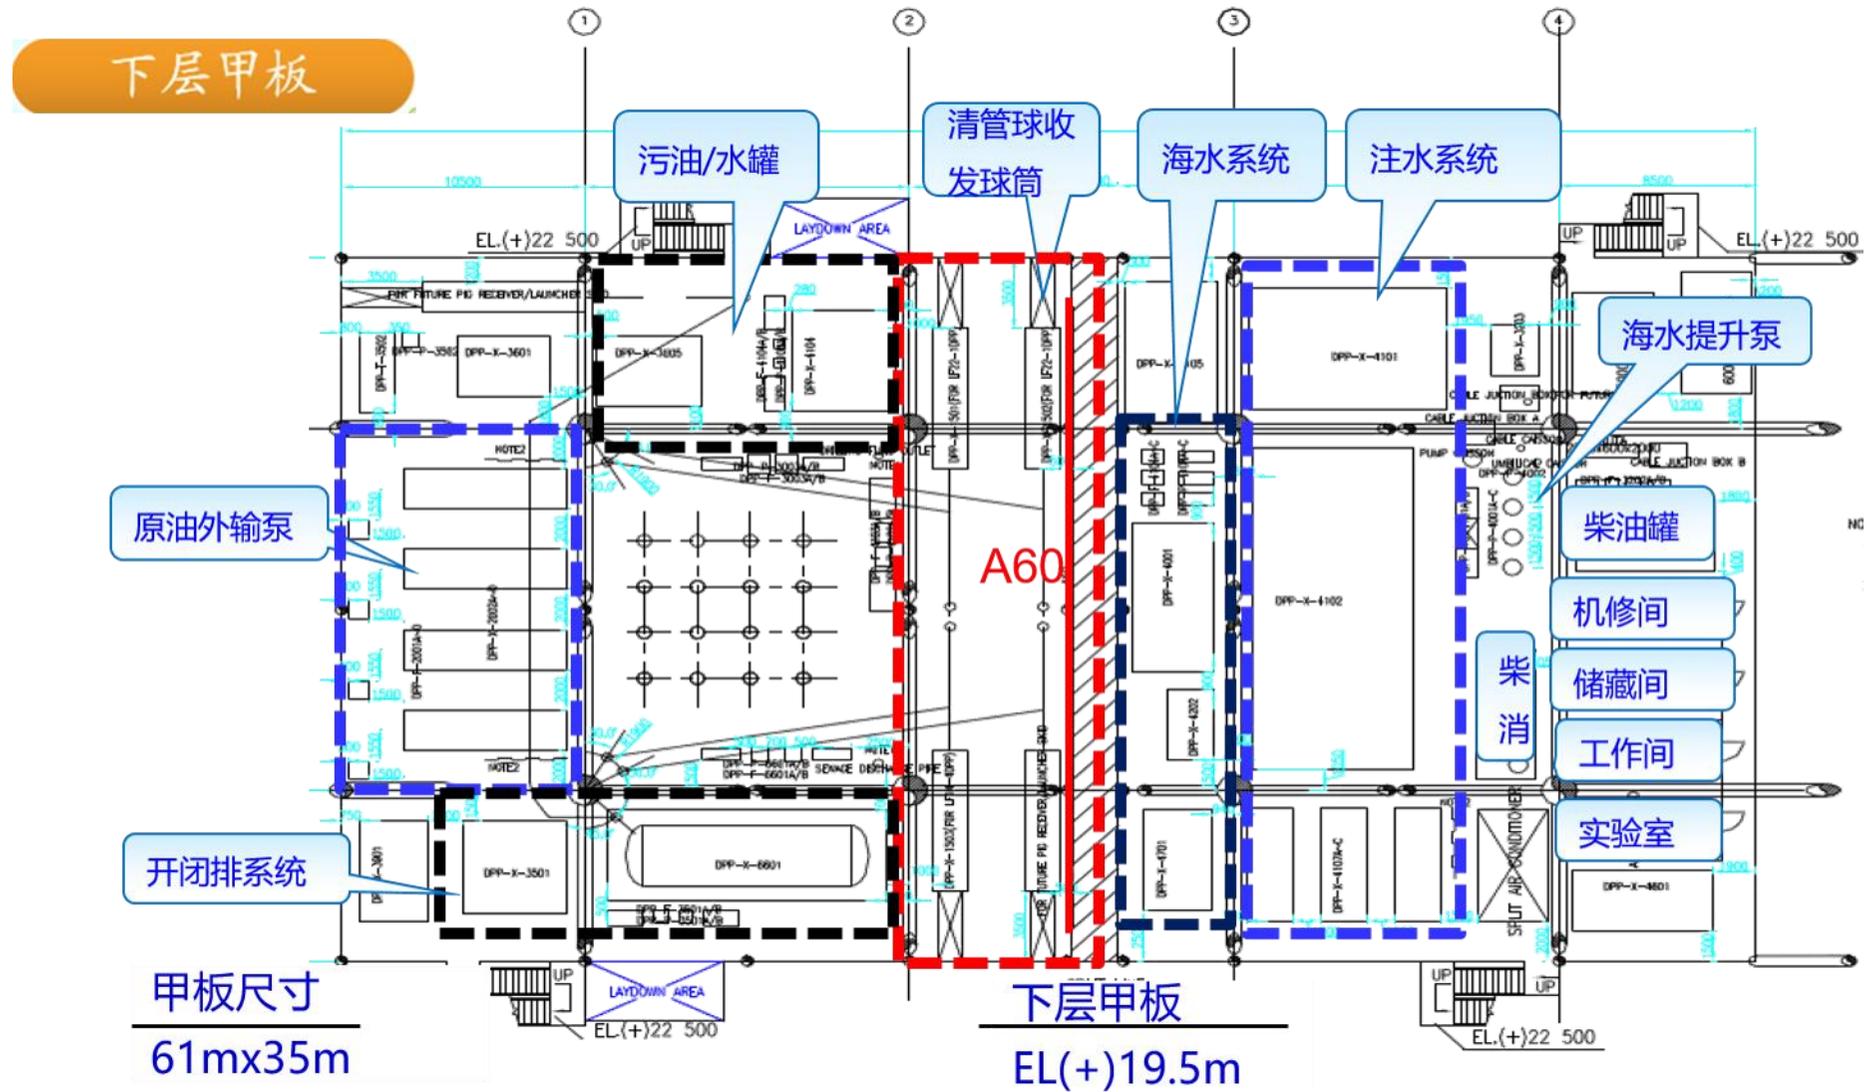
新建 LF15-1 DPP 平台下层甲板平面布置图
